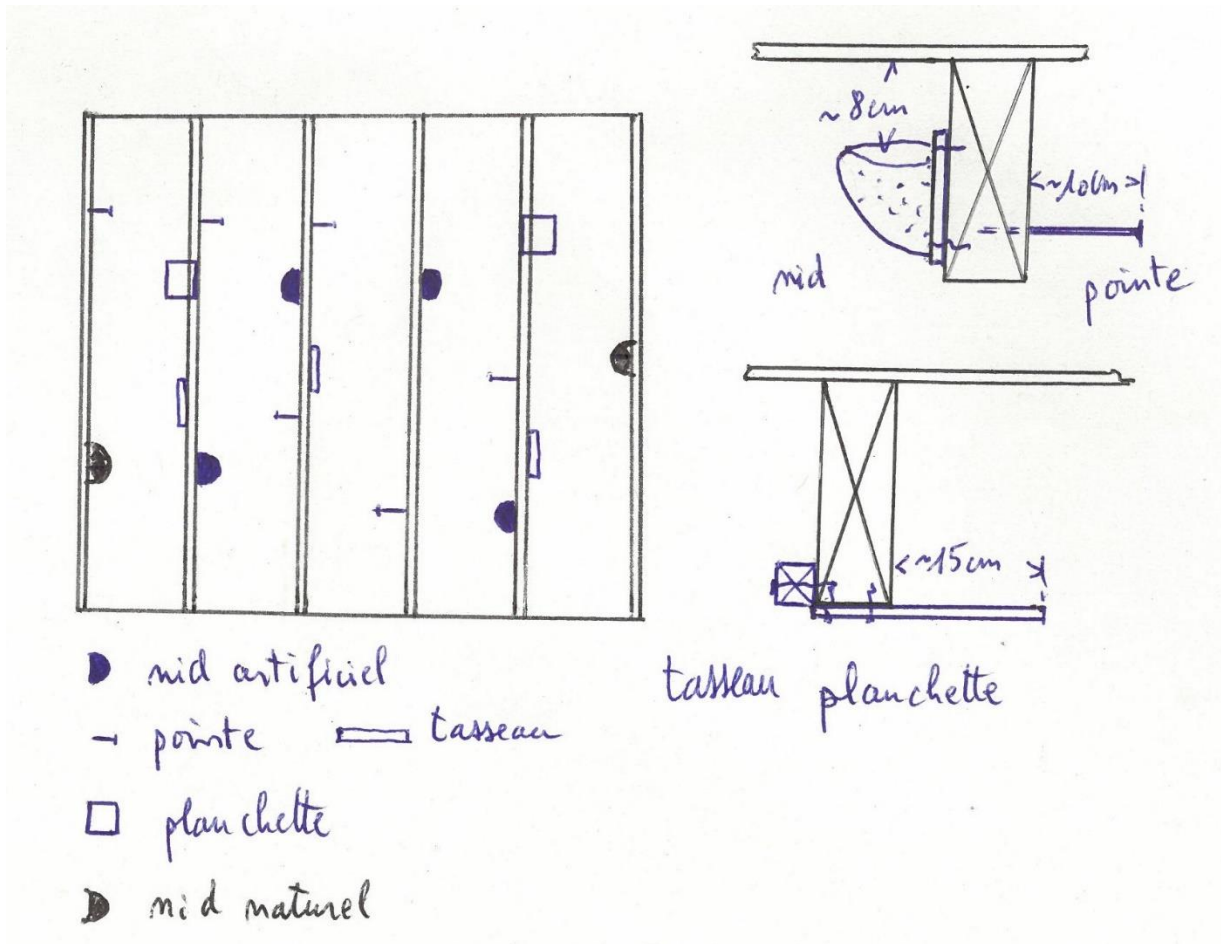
schéma de principe de l'équipement du plafond du « bâtiment nichoir », vu en plan (LPO)
